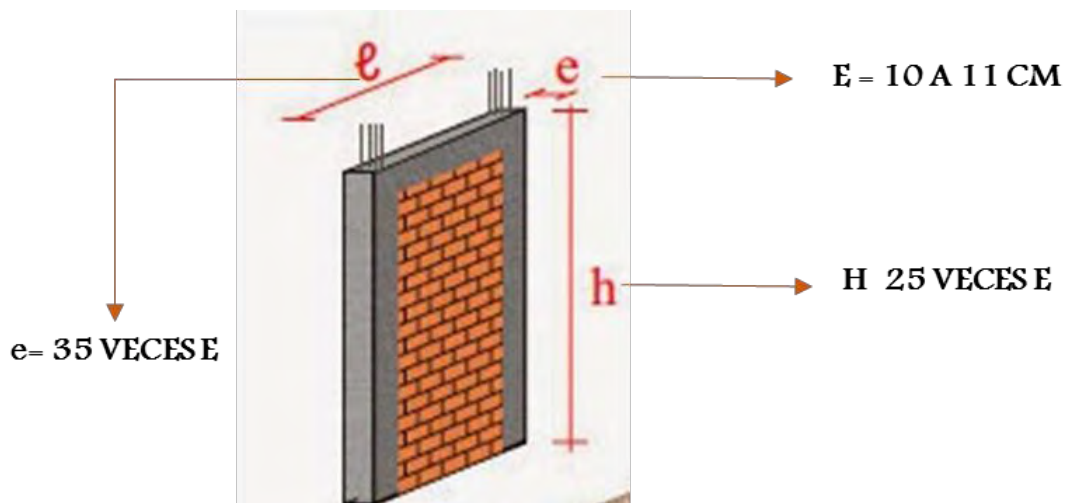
Ilustración especificaciones de un muro en mampostería, NSR-10
